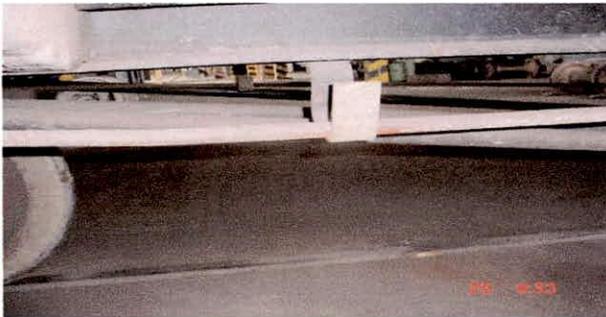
Varilla con el soporte soldado a la viga central
